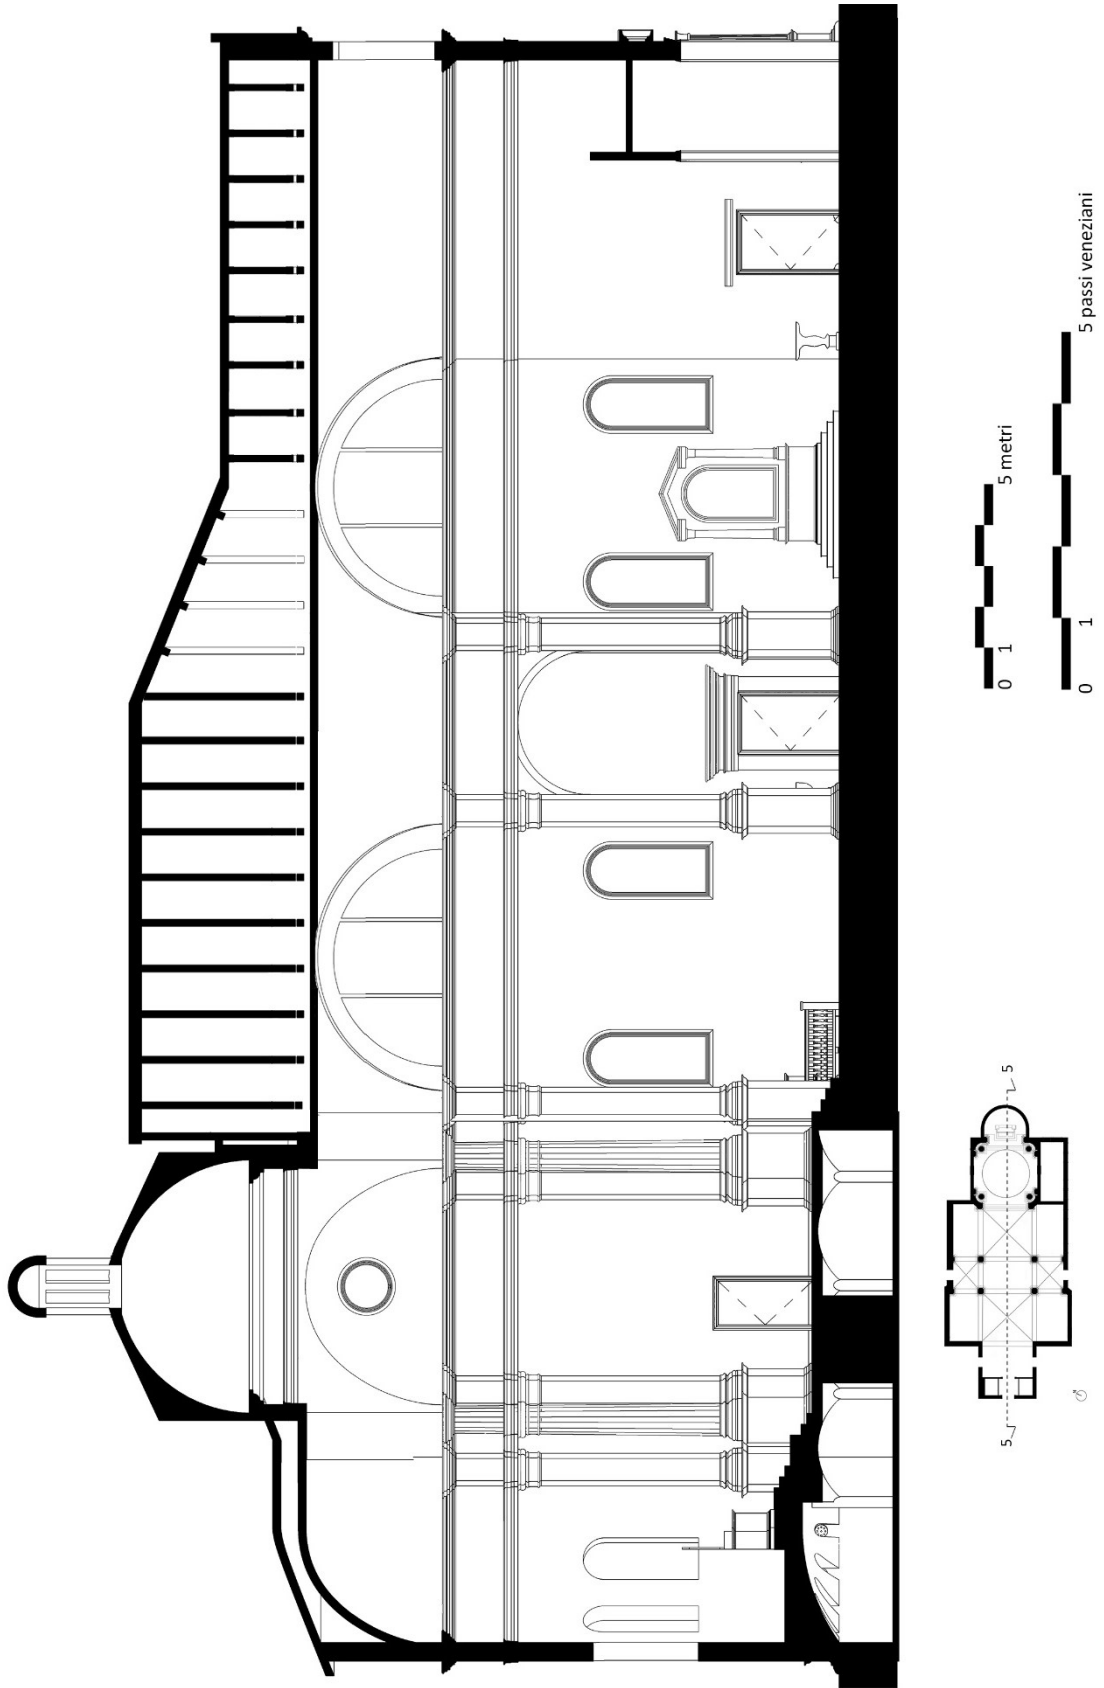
Stato di fatto. Sezione longitudinale 5-5.
